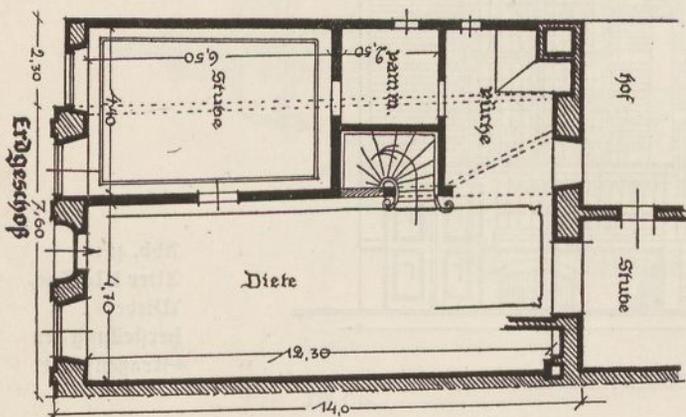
und 49: Wilhelmstr. 29, Grundrisse von Erd- und Obergeschosß
